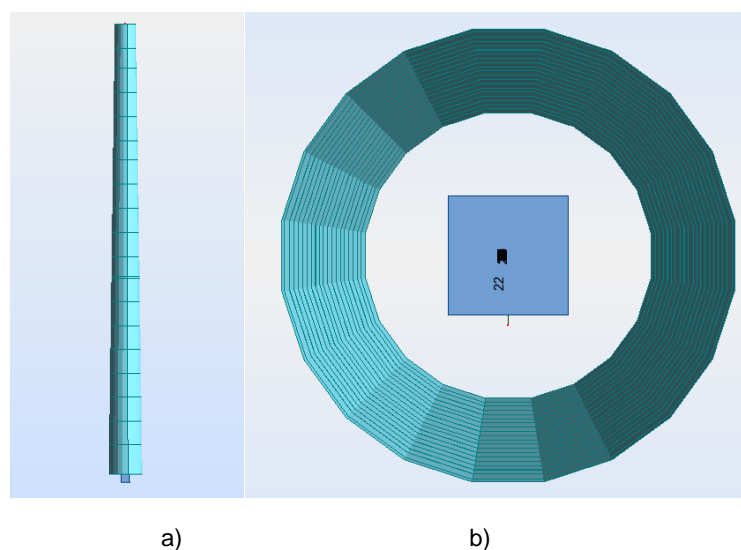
a) Modelo de barras encastrado; b) Pormenor da discretização do círculo e do apoio encastrado
